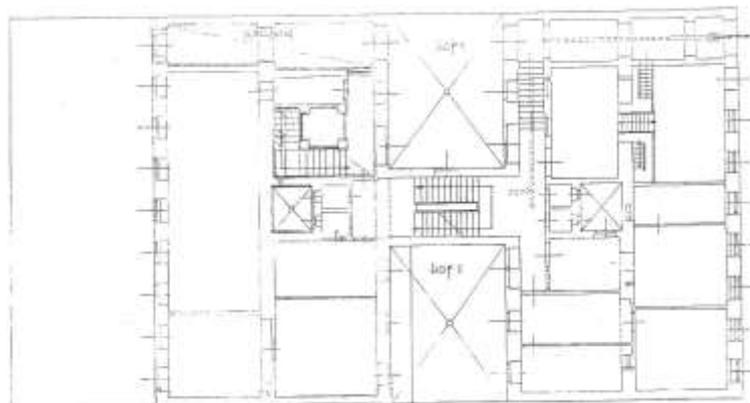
Grundriss Ramperstorffergasse 23 [Quelle:
